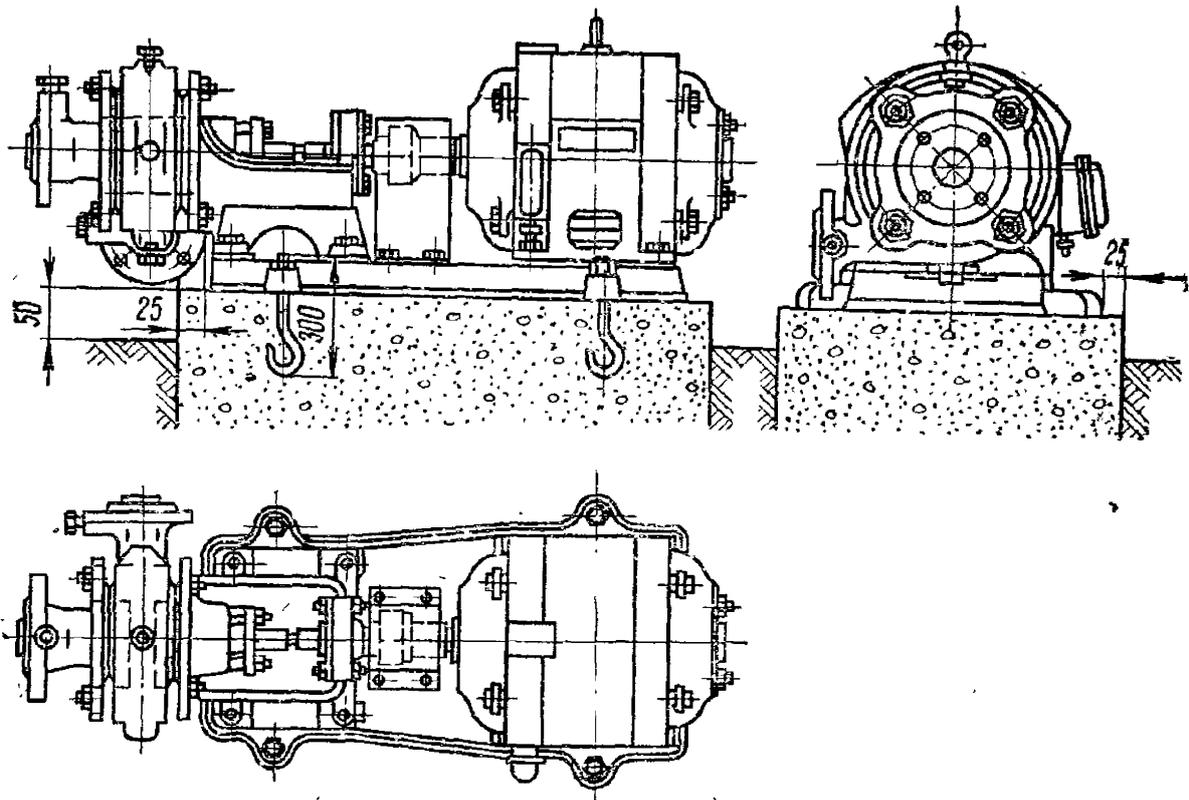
Установочный чертеж центробежного насоса типа К
